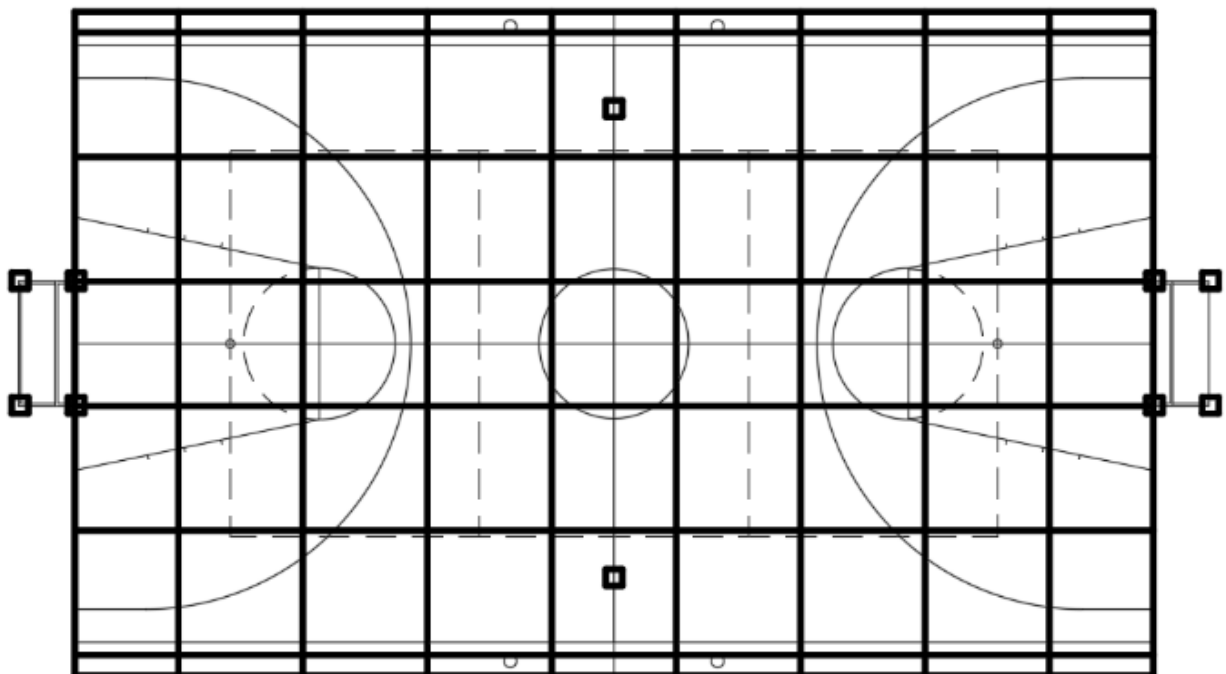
Detalle de las juntas de dilatación y anclajes para los arcos. Elaboración propia.
